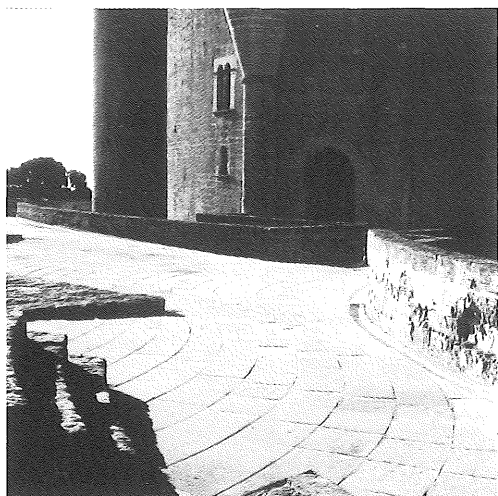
Restauración del Castillo de Bellver en Palma de Mallorca. Arquitectos, J. A. Martínez Lapeña y Elías Torres (1983-85). Detalle del pavimento.
